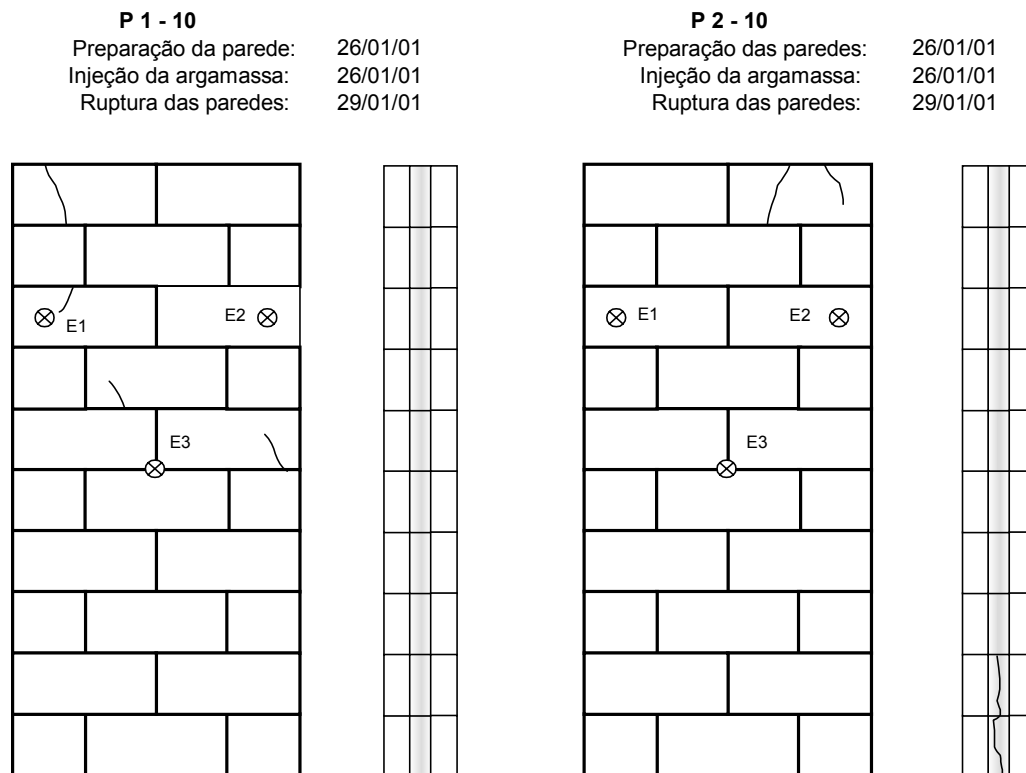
Mapa de fissuração das paredes com 10 fiadas – P1 e P2
